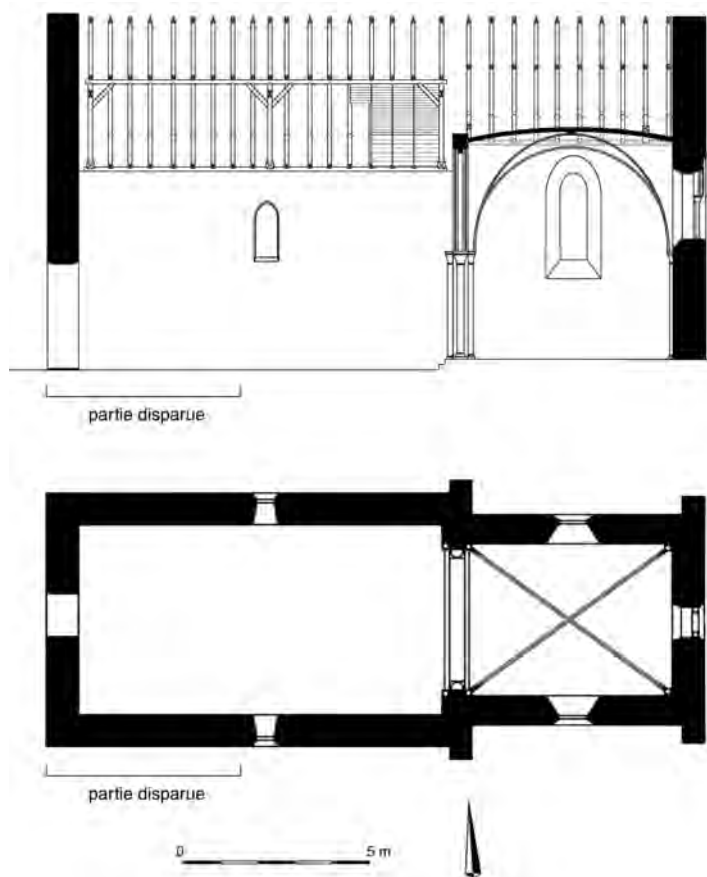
Chapelle Saint-Laurent de Vaux à Gisors (Eure) : restitution, coupe longitudinale ouest-est et plan (1224d).
